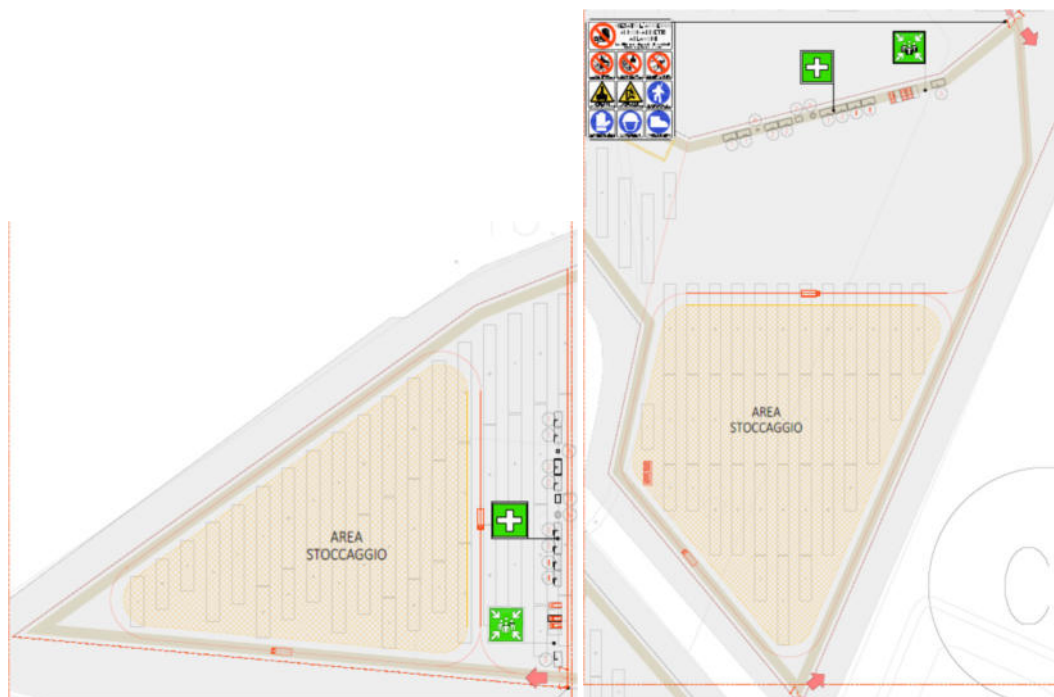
Localizzazione e struttura delle aree di cantiere (Rif. 2800_5152_SIGON_PD_R01_T08_Rev0_PLANIMETRIA CANTIERE).
